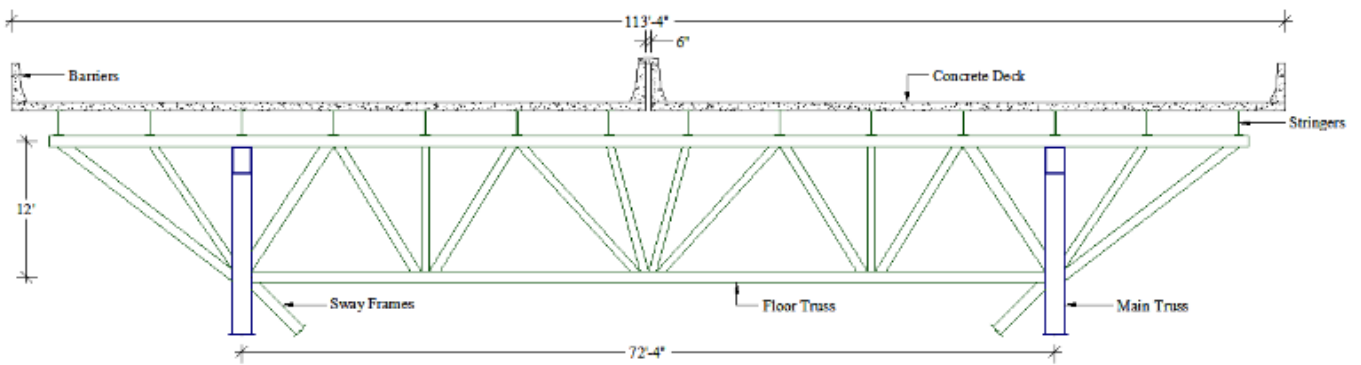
Perfil transversal da ponte I-35 W. [7]
